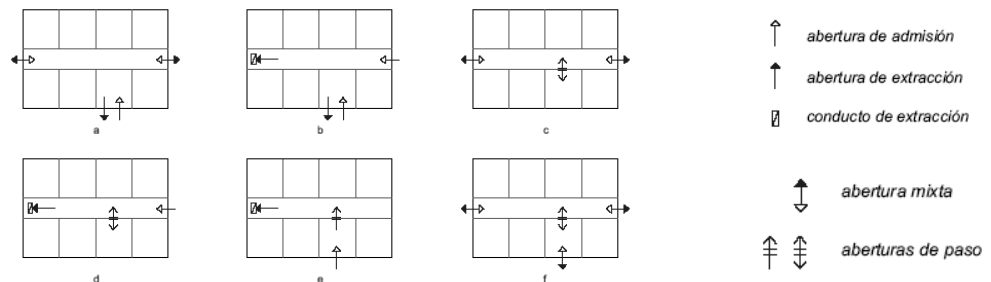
Ejemplos de ventilación en el interior de las viviendas
